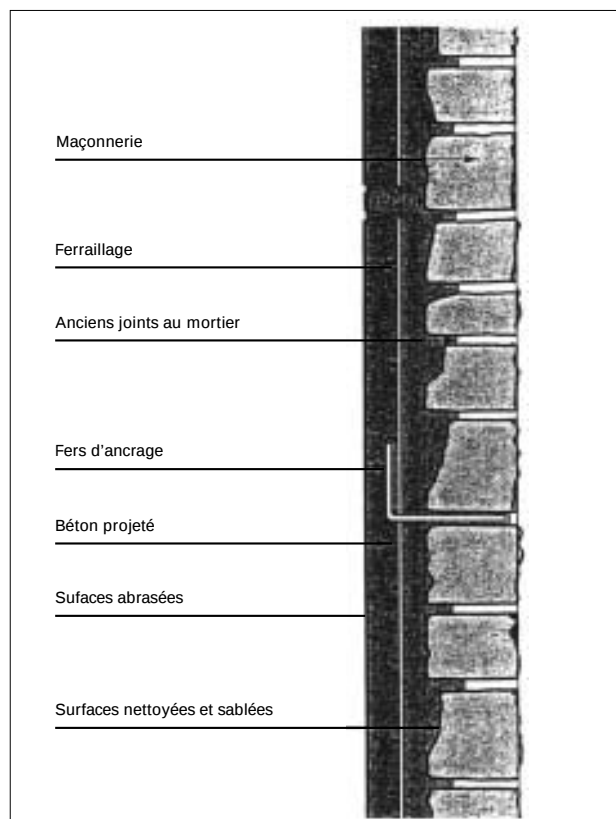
Nouvelle couche de béton projeté sur une maçonnerie en pierre naturelle [4.40]
